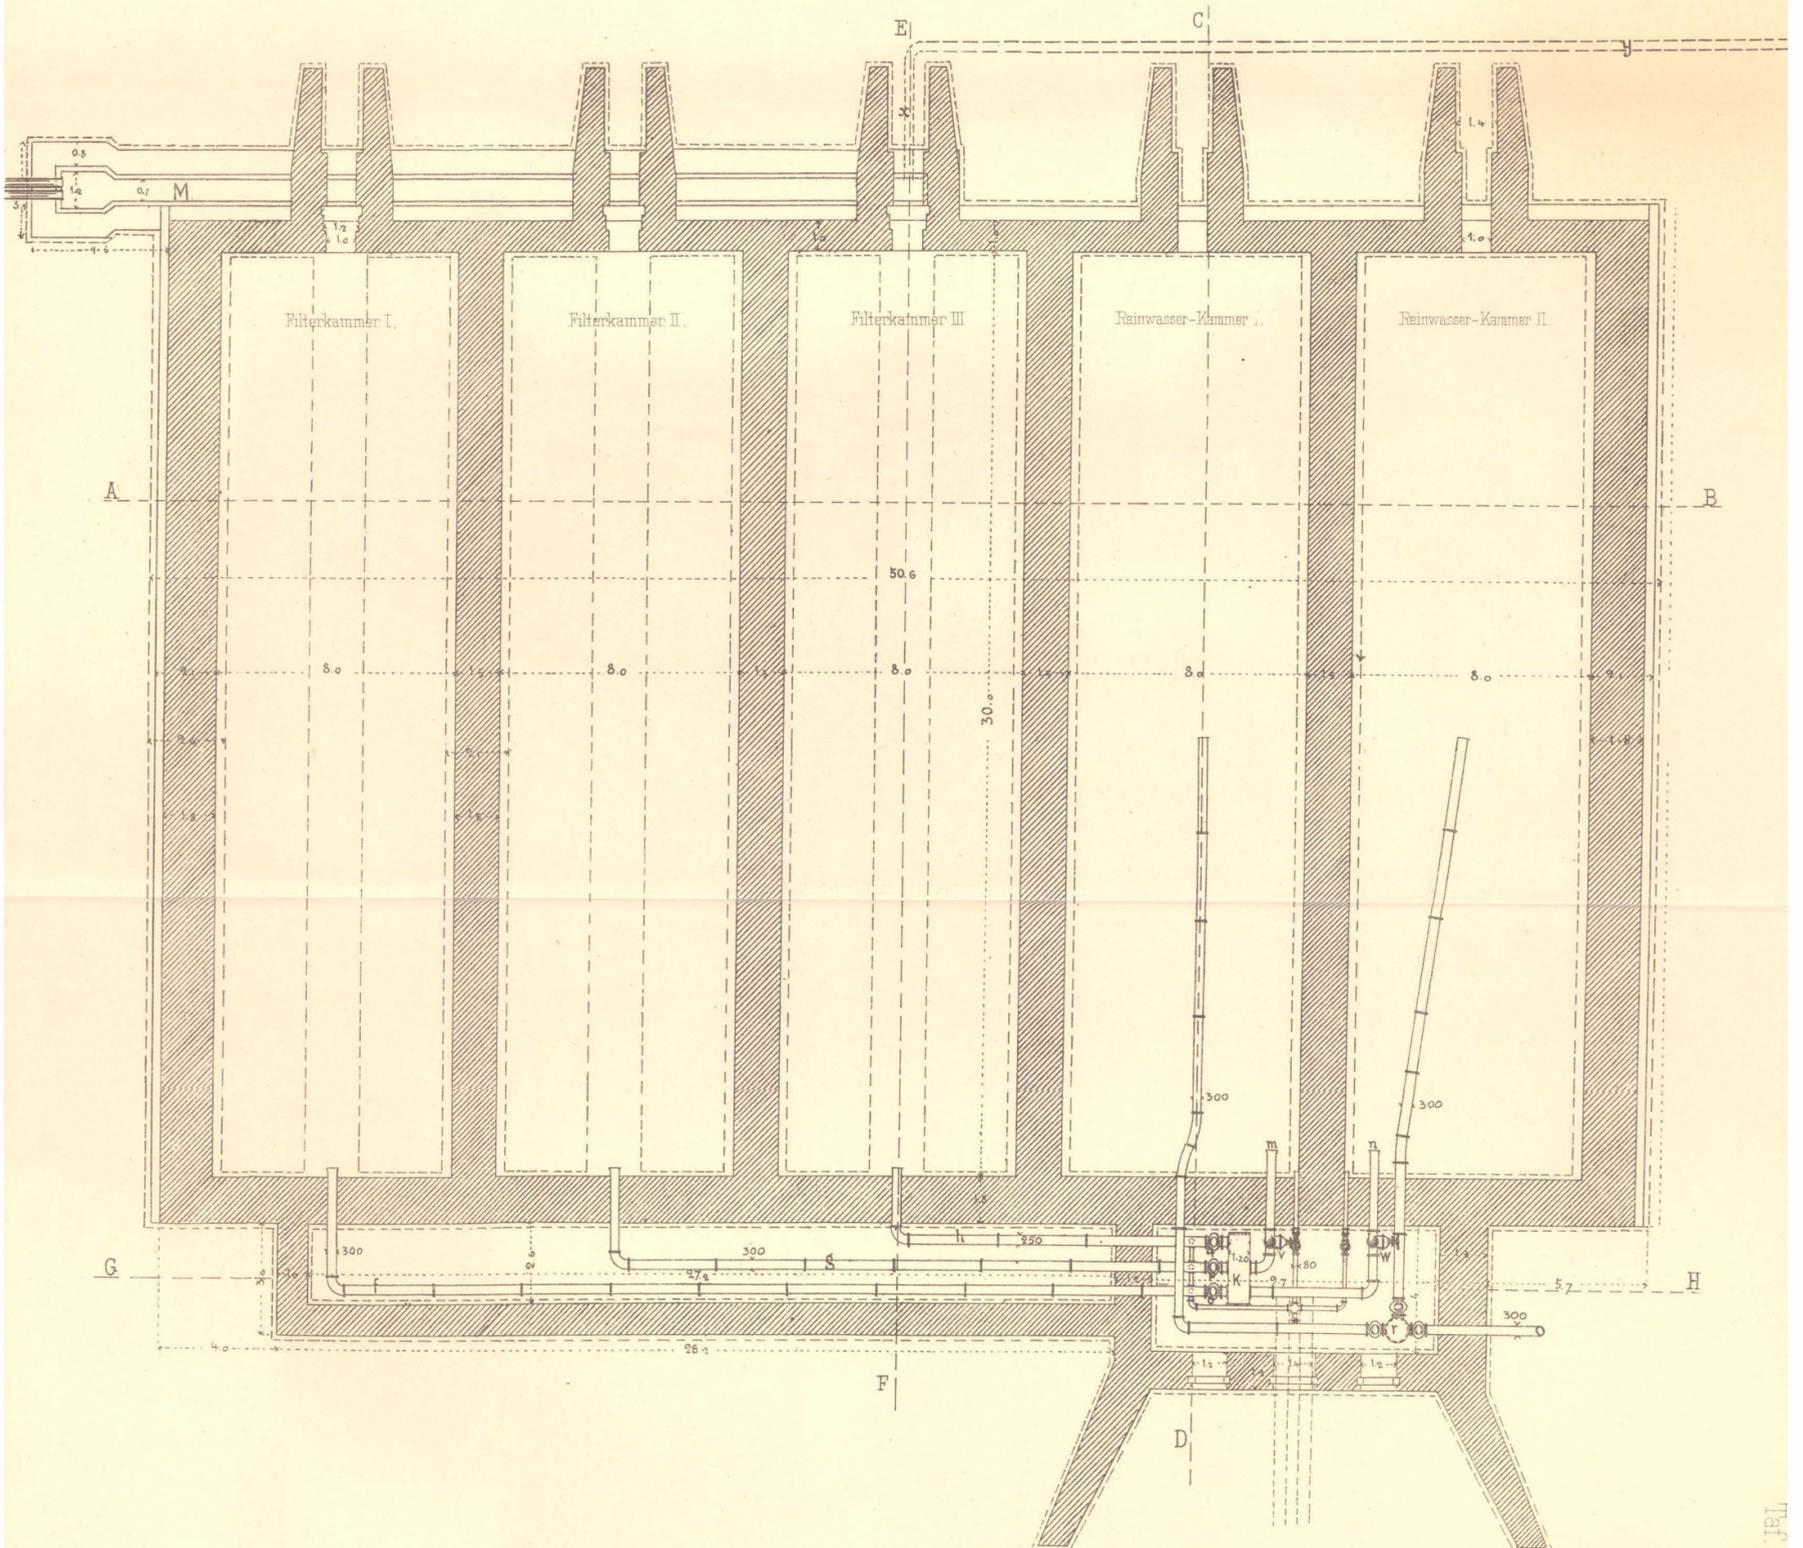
Grundriss der Filter- und Reinwasser-Kammern und der Schieberkammer
